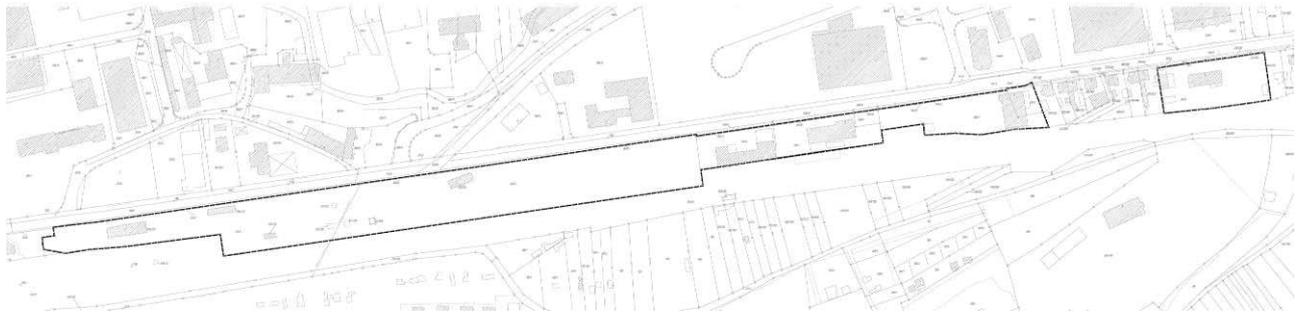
Lageplan mit Geltungsbereich (Quelle: Stadtverwaltung Bad Blankenburg, Bauamt 14.08.2013)
